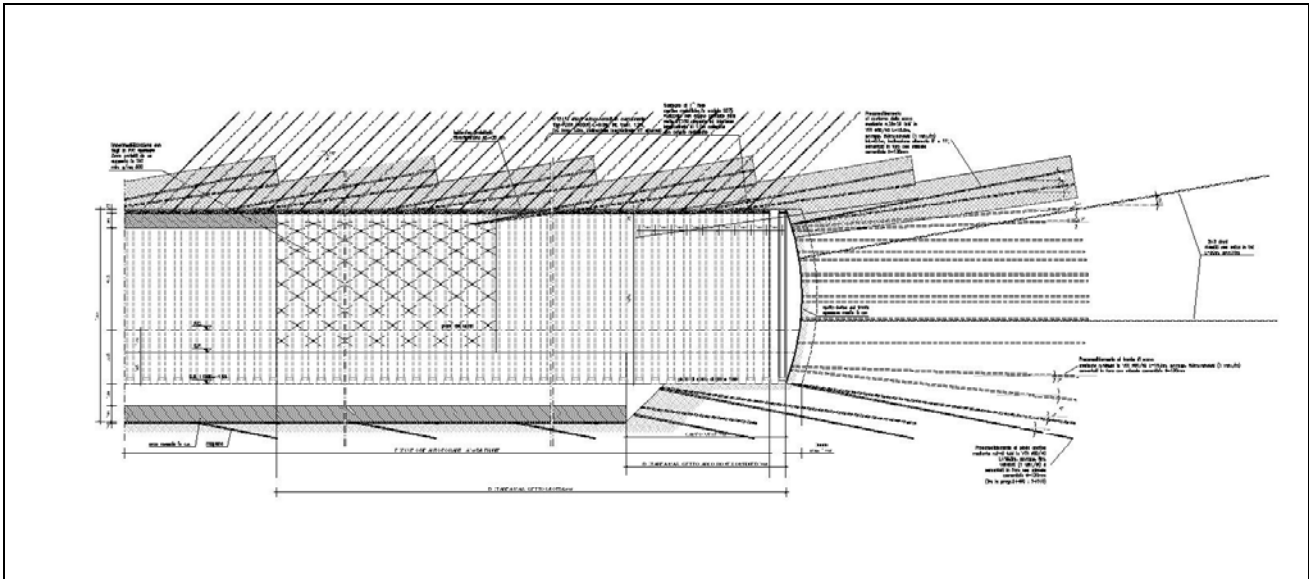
Sezione di scavo tipo GD-B1 IN FAGLIA - Sezione longitudinale
